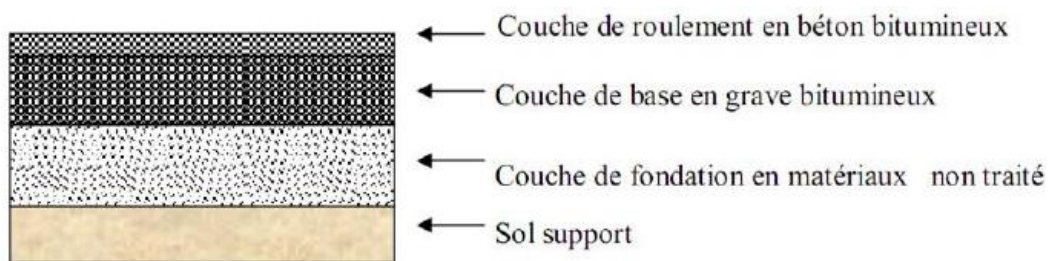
Modèle d'une chaussée souple (LCPC, SETRA, 1998).
